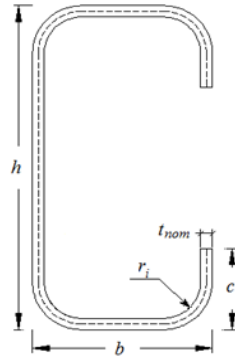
Secção transversal tipo dos elementos de aço enformado a frio
